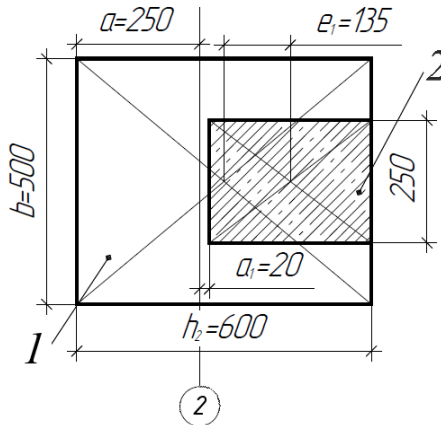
Приклад опирання ригеля на колону:
